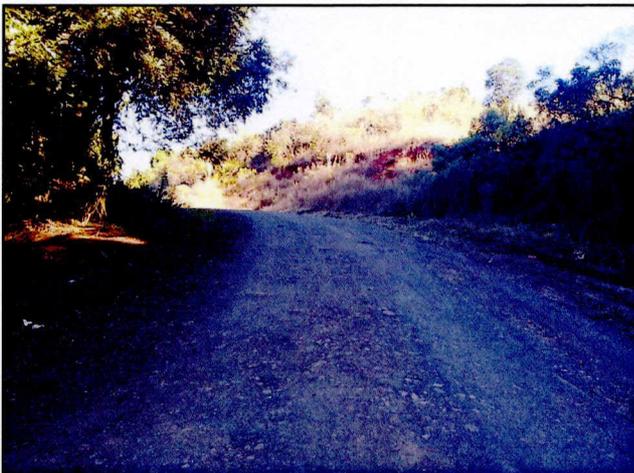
vista central do leito da Rua existente a ser regularizada;
